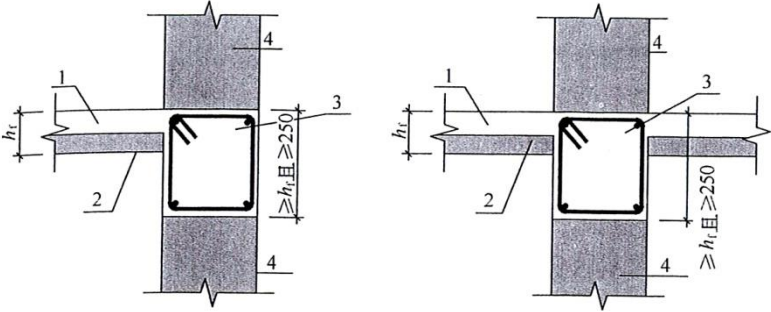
后浇钢筋混凝土圈梁构造示意
